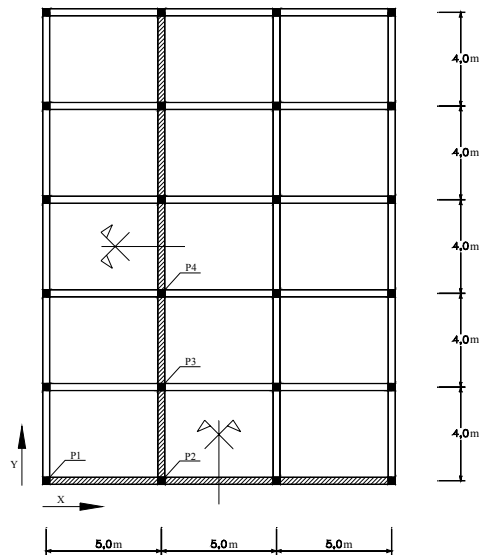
Secções dos pilares considerados para a pormenorização de armaduras apresentada.
